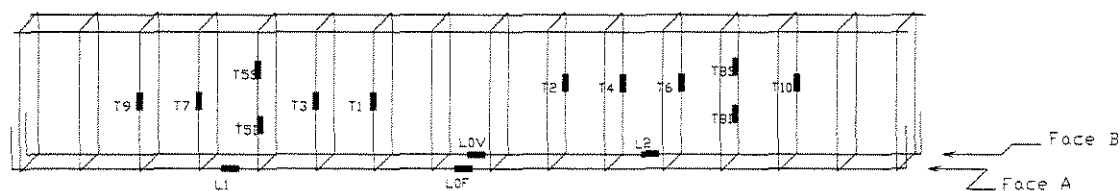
INSTRUMENTAÇÃO NAS ARMADURAS
